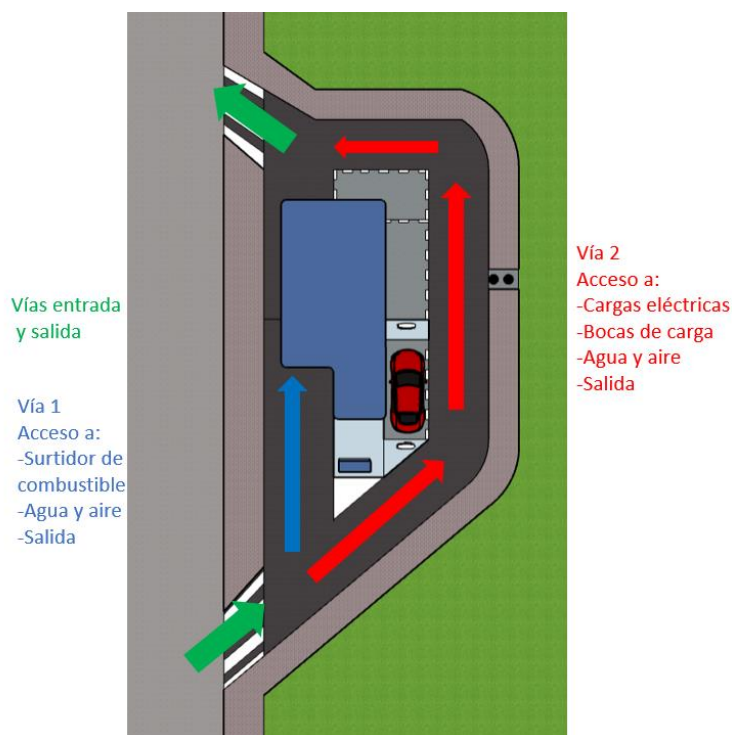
'Vista en planta con explicación de las vías y sus accesos' (Propia, SketchUp)
